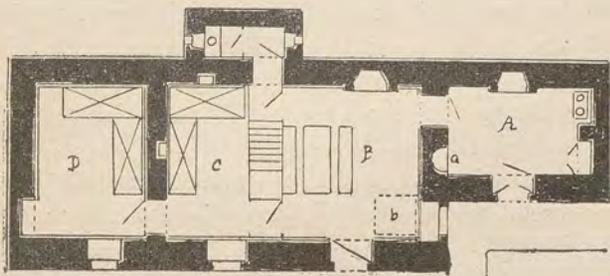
Pianta della capanna « Grigna Vetta ». Piano terreno.
